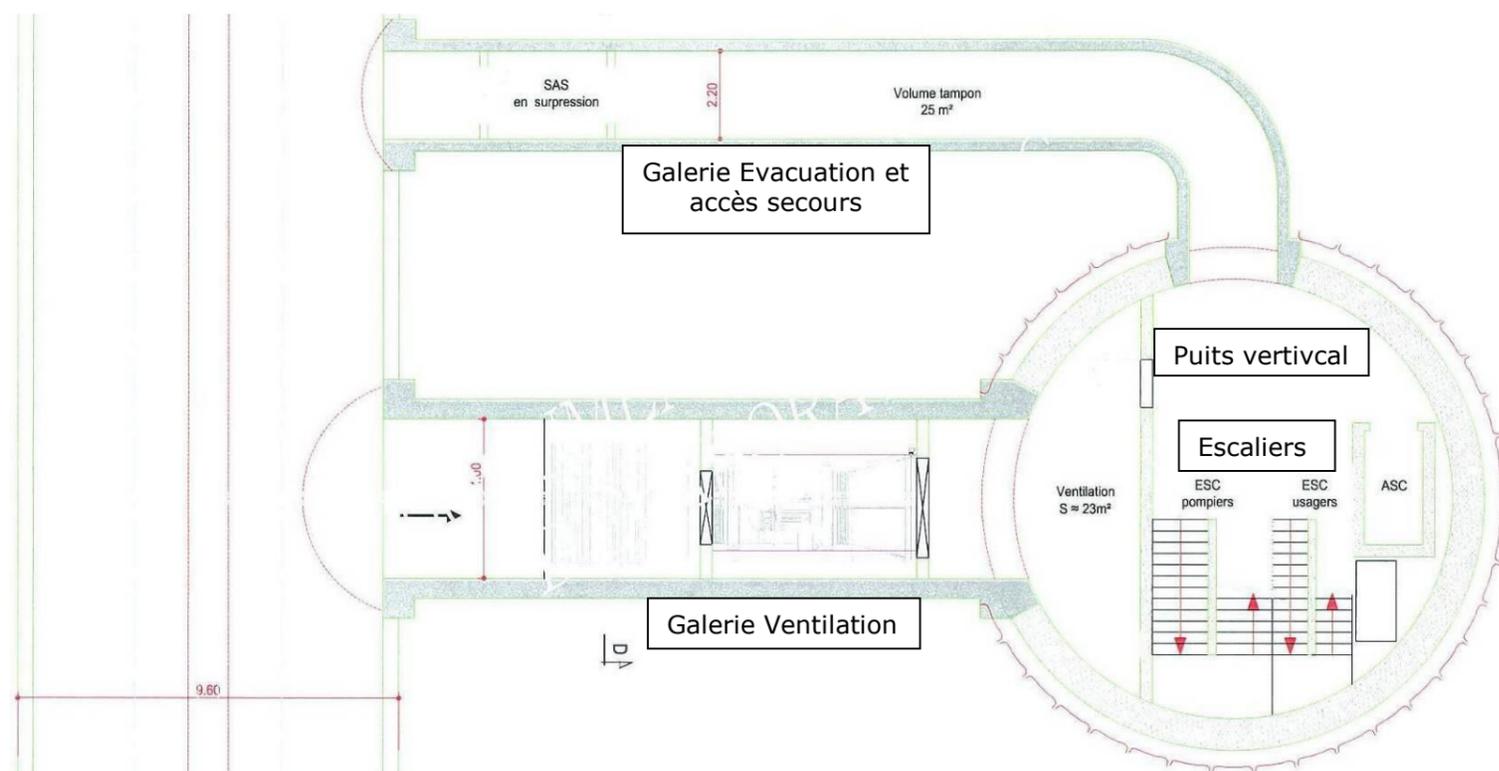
Schéma de principe d'un puits de ventilation et d'accès secours - vue en coupe plan horizontal - Source SETEC-Etudes préliminaires
